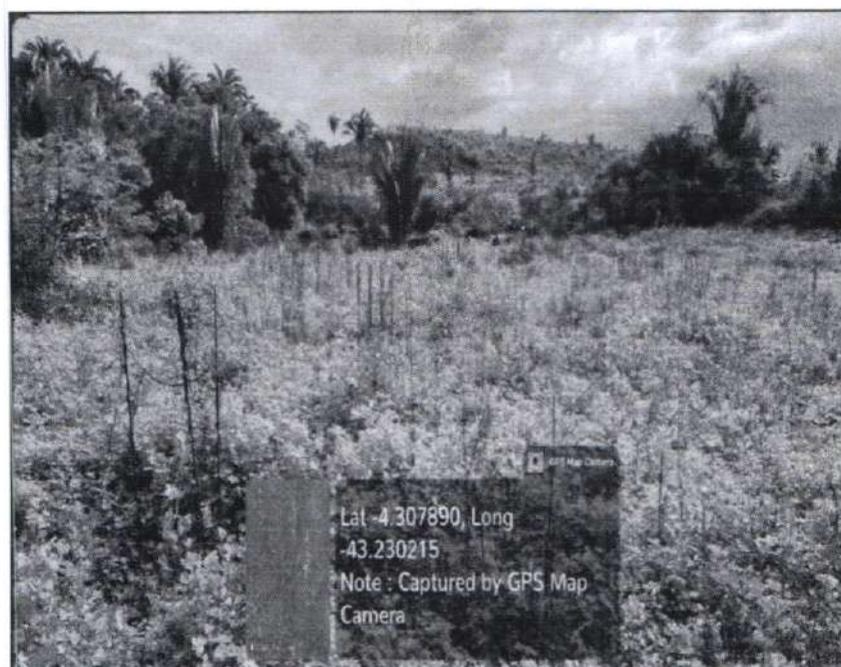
Ferragens dos blocos de fundação sem concretagem previstas e expostas a intempéries. Fonte: elaboração própria
